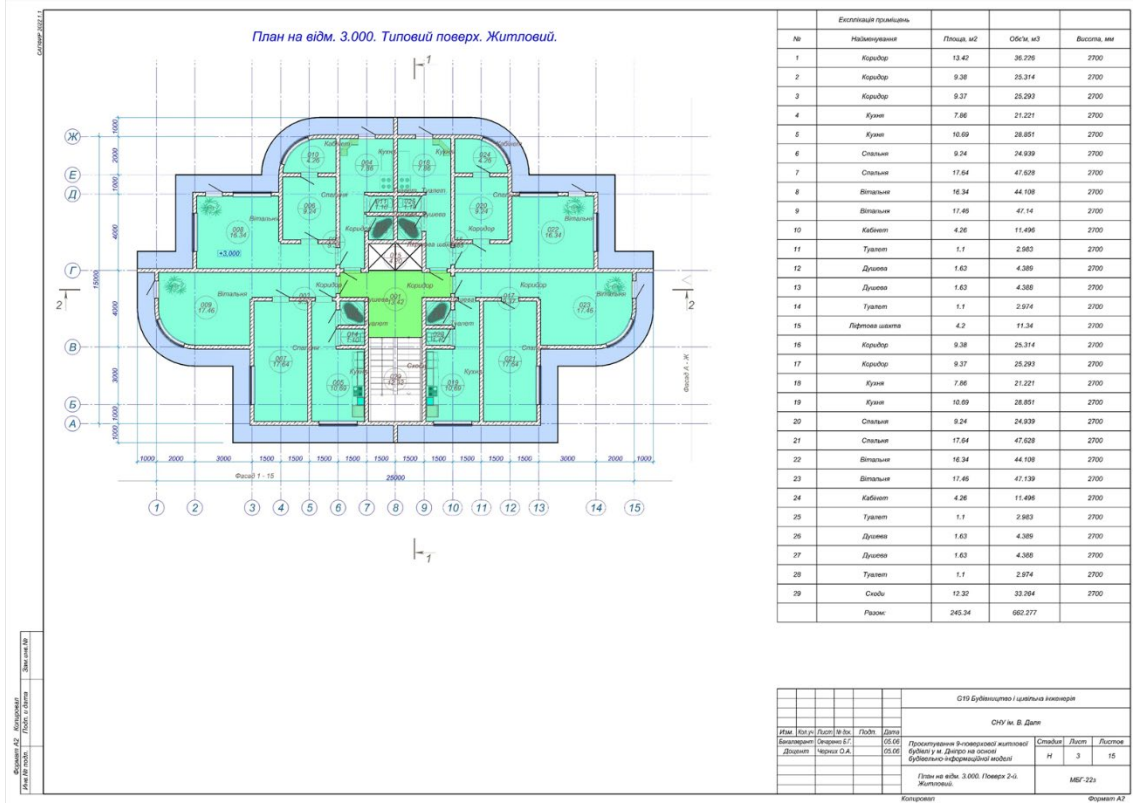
План на відм. 3.000. Типовий поверх. Житловий.
